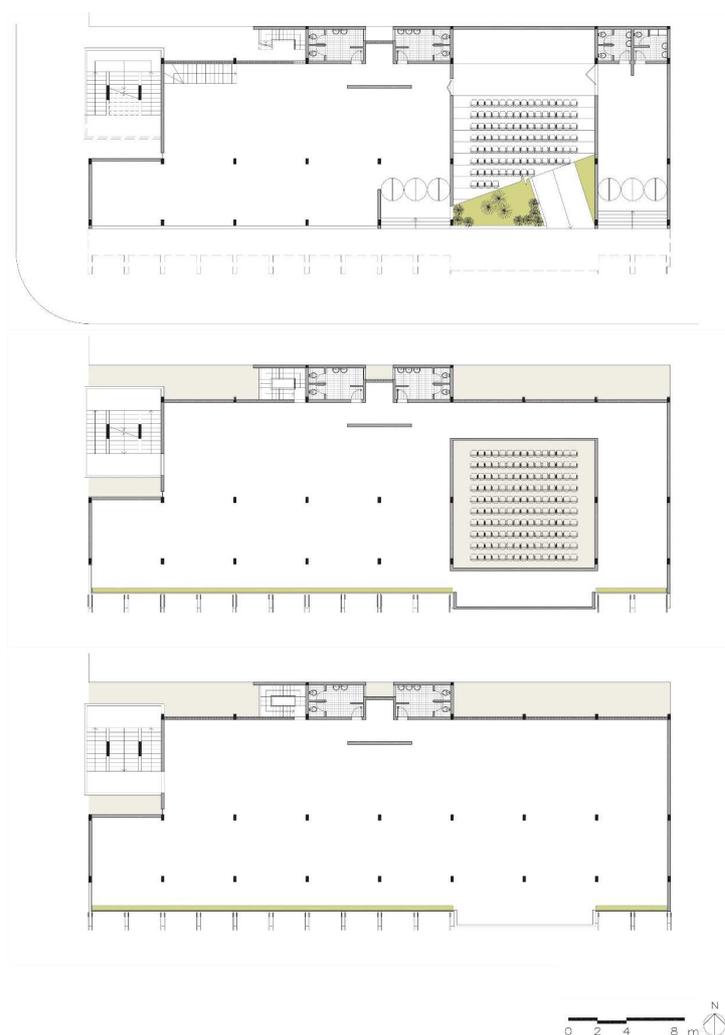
Plantas do térreo, primeiro e segundo pavimento. Fonte: Redesenho elaborado pela autora com base em projeto legal da prefeitura, 2014.
